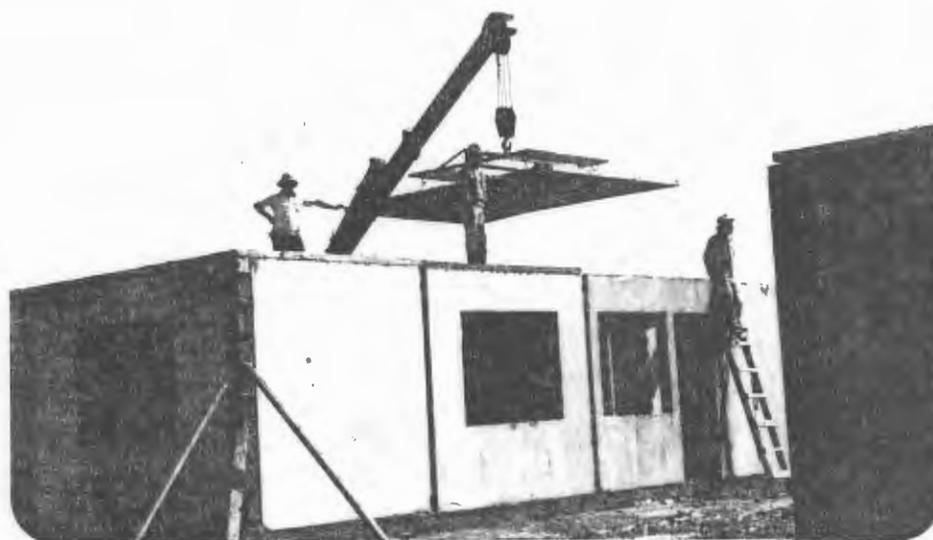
Montagem de residência com sistema construtivo pré-fabricado de concreto
